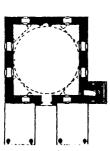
مسقط أفقى لتربة حاجى سلطان في بورصة (أو بروسة) . (عن : Wilde) .
